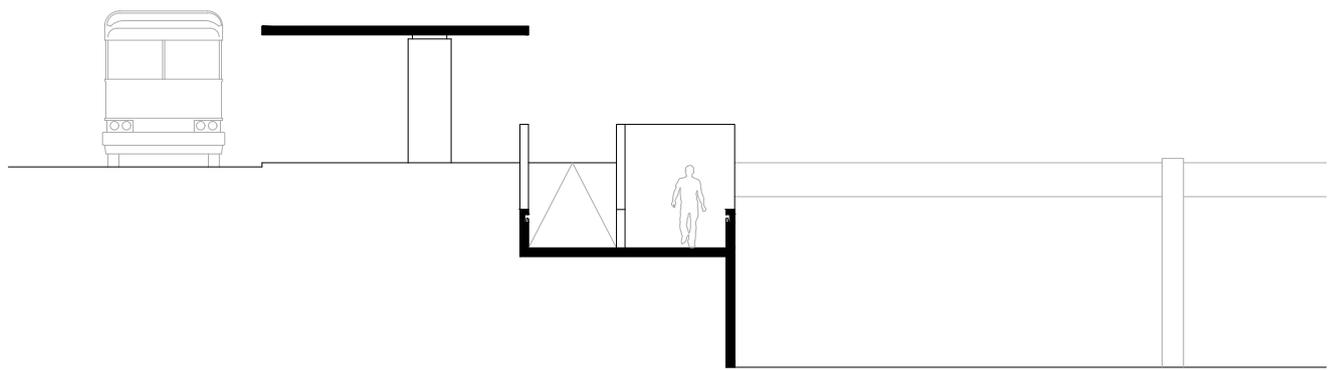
Corte transversal da paragem de autocarros na Avenida Ferreira Godinho, redução da escala 1/100.
